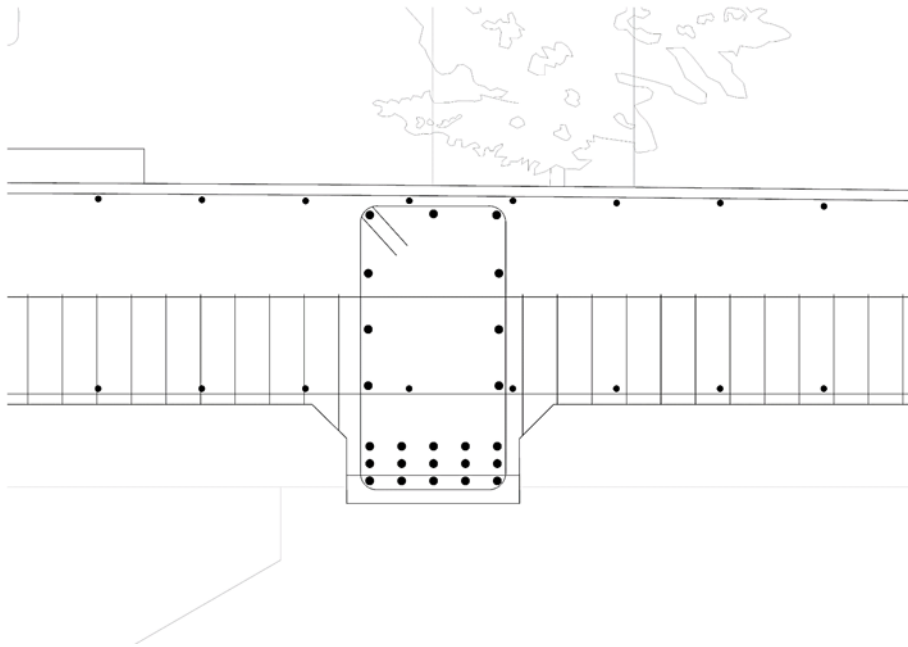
Detalle Superestructura. Elaboracion propia, (AutoCad).
